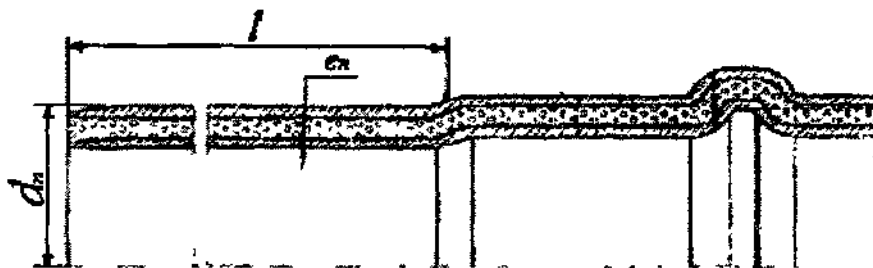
Будівельна довжина труб розтрубних типу А
